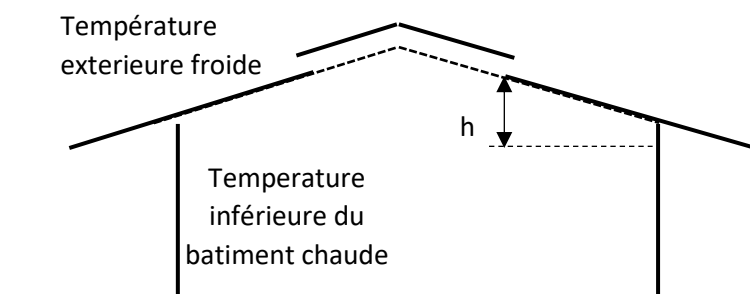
plan type du bâtiment d'élevage proposé dans ce projet
